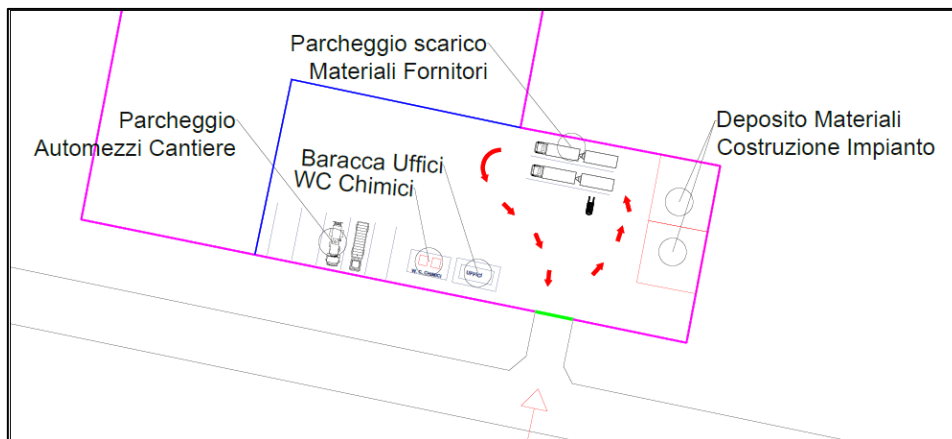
Schema tipo della suddivisione delle aree di cantiere
